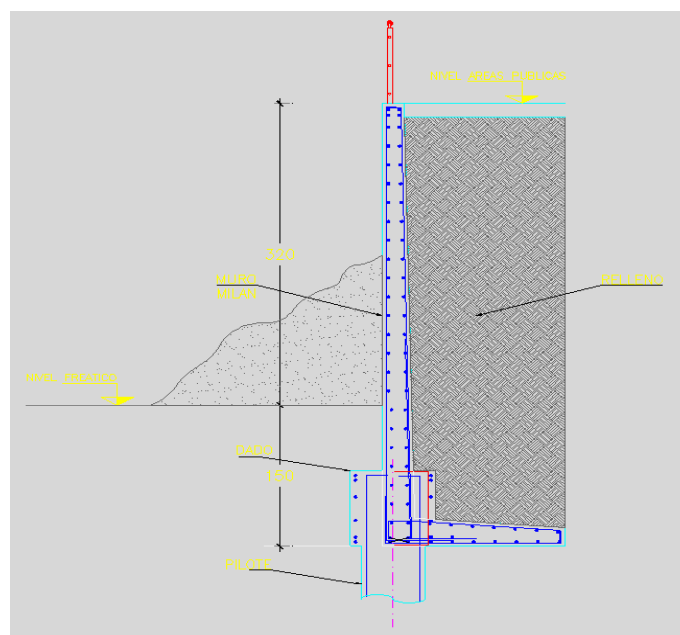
Detalle de obra del murete de contención planeado para el frente de playa.
